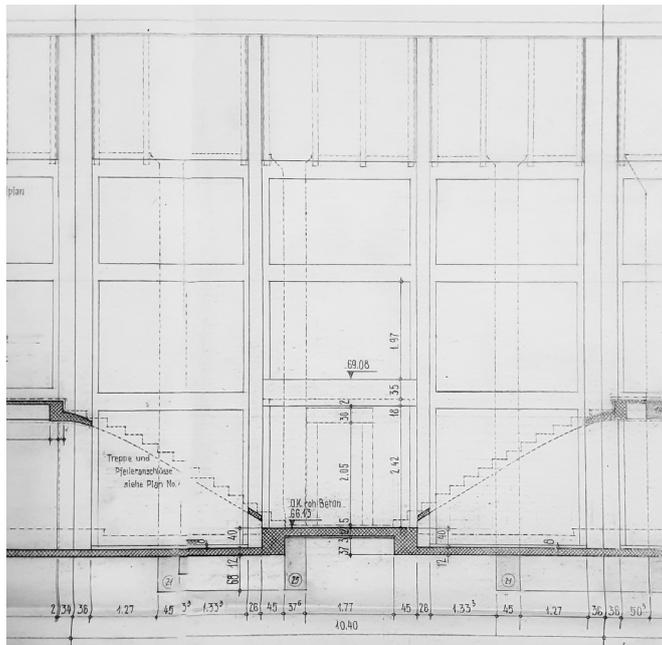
Planansicht Innen - unausgefachtetes Betonskelett
